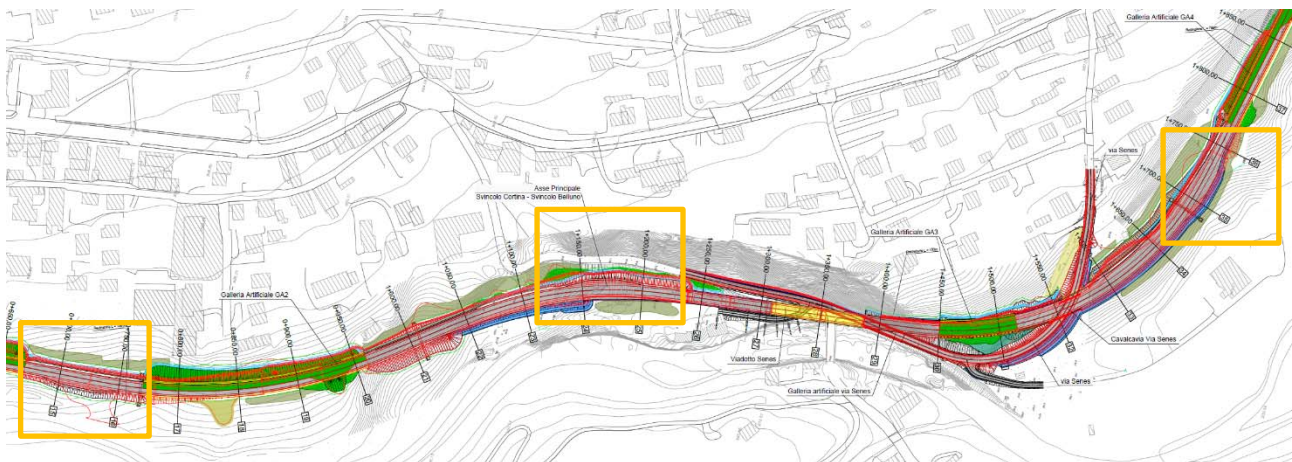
Stralcio planimetrico confronto PD-PE con nuova posizione delle piazzole di sosta
